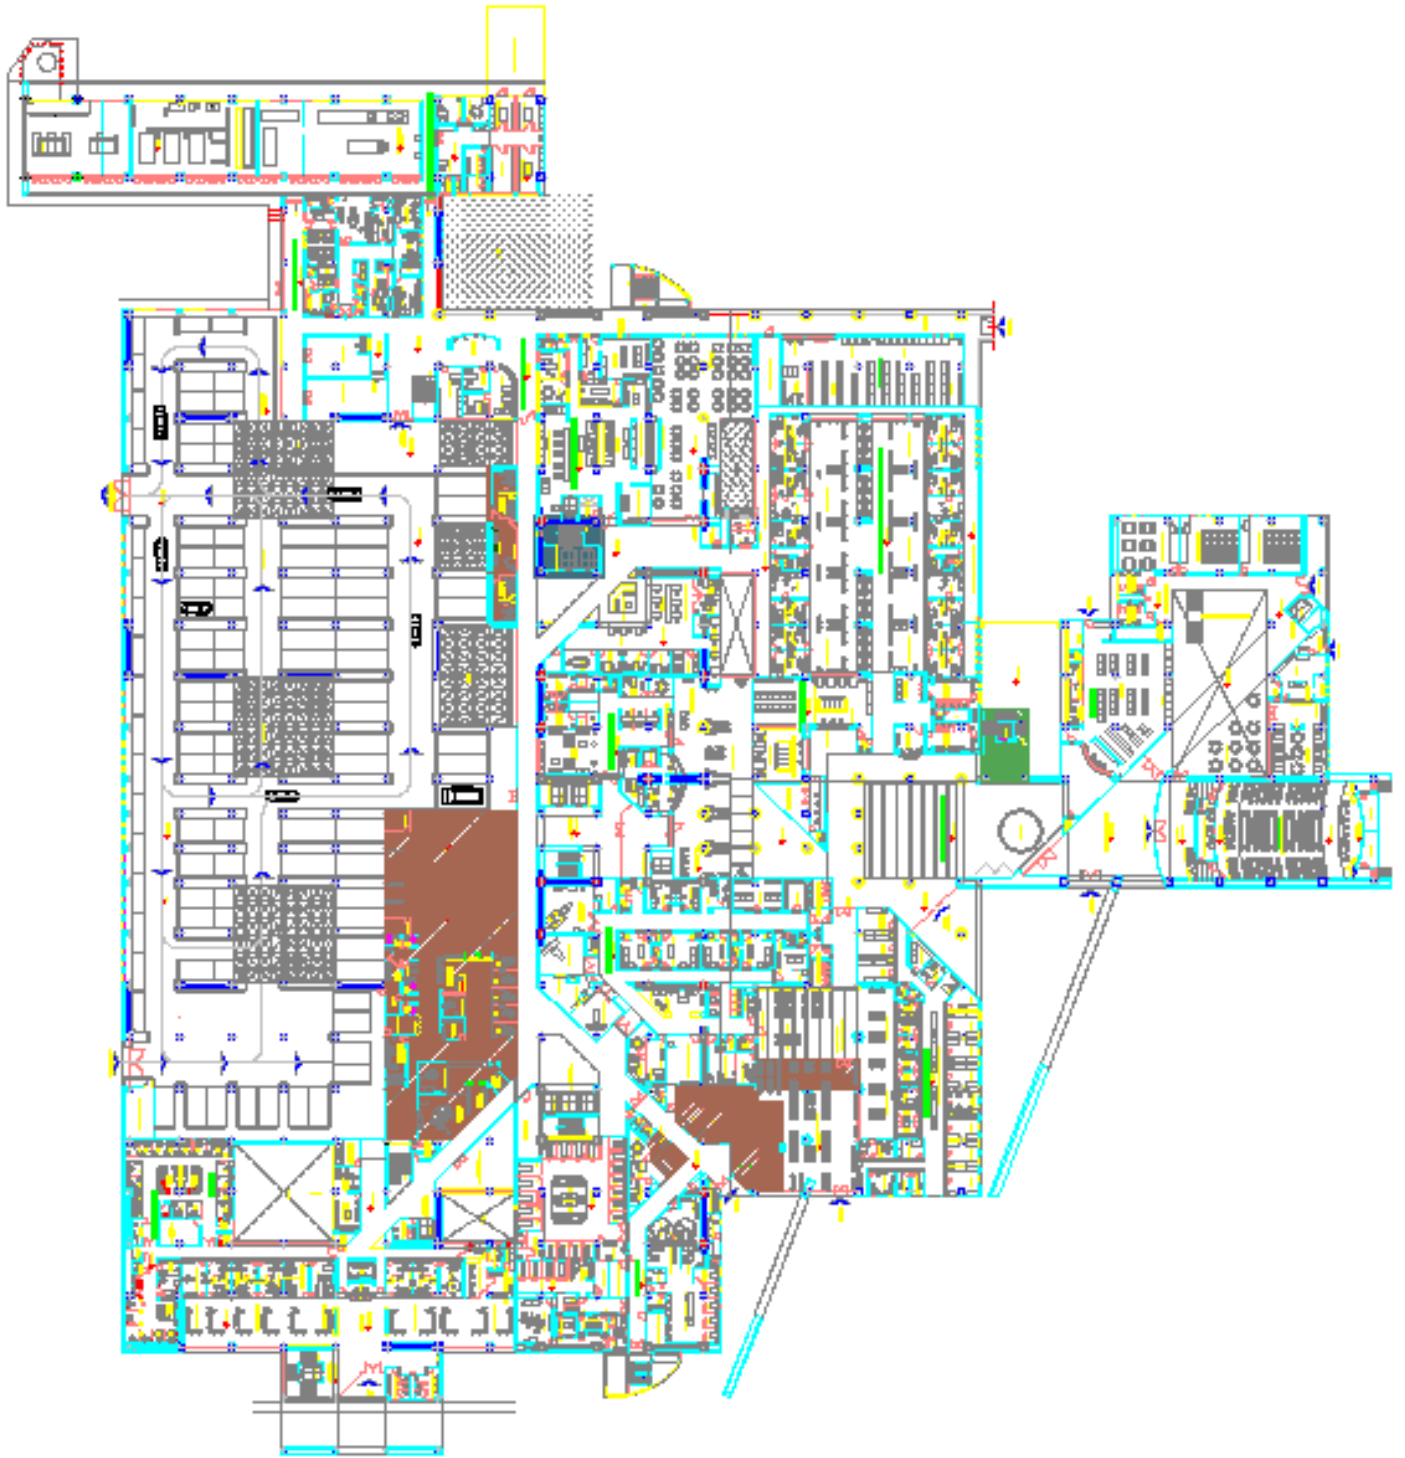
PLANTA BAJA (VISTA EN PLANTA)
